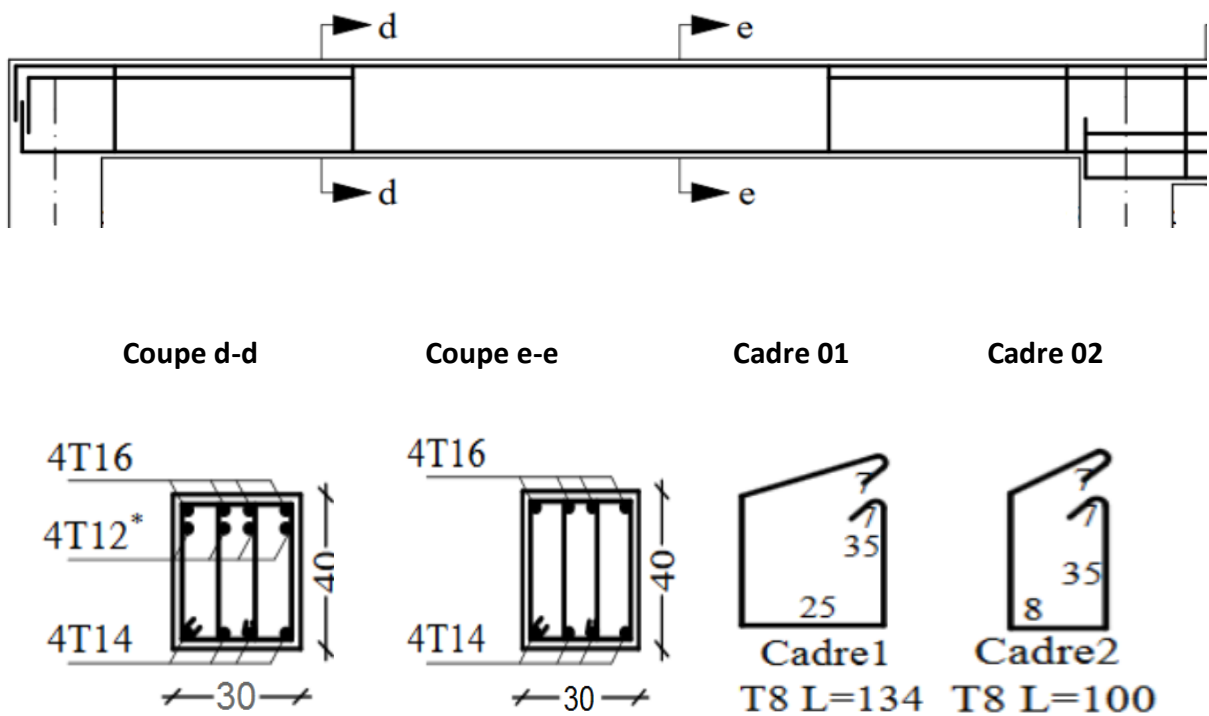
ferrailage de la poutre secondaire (30×40)
